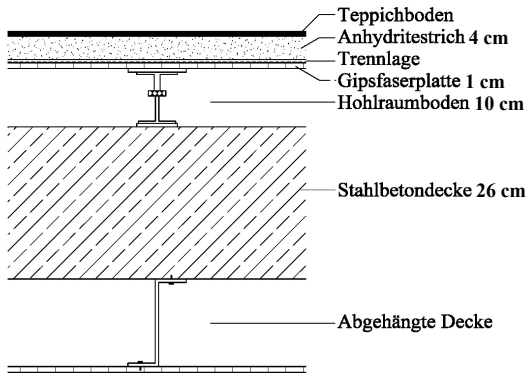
Deckenaufbau (Decke über EG, 1. und 2. OG)
